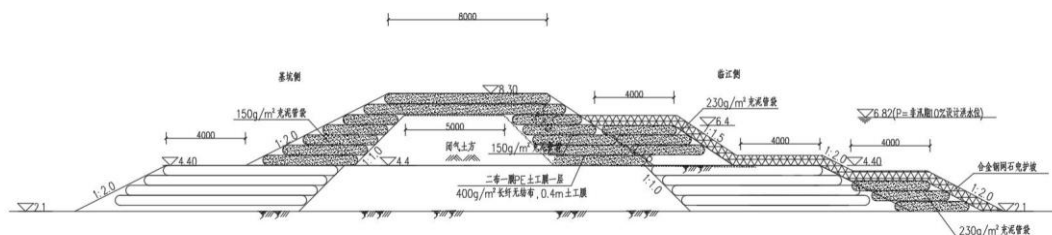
小江闸站外江侧围堰典型断面图（单位：mm）
